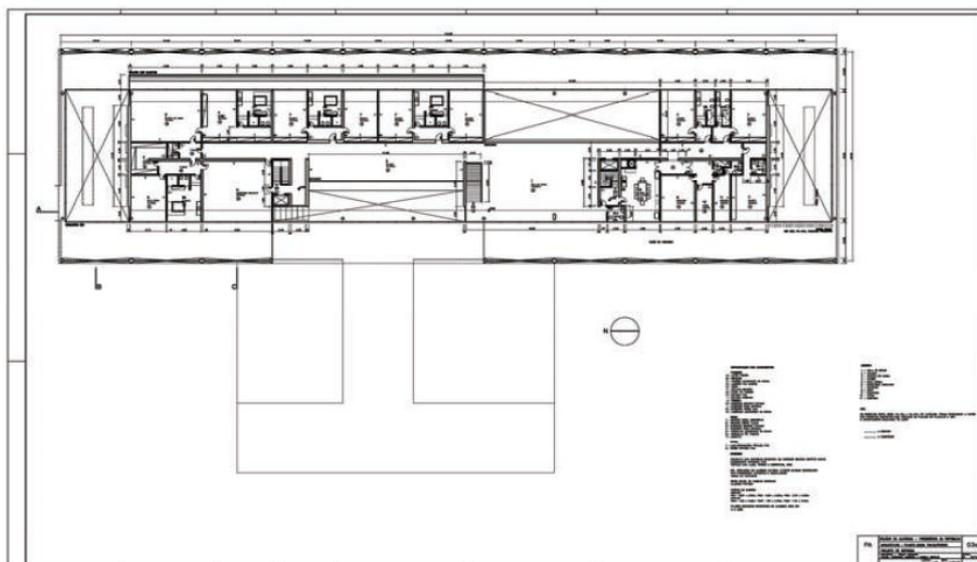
Planta Baixa Original – Pavimento Superior do Palácio da Alvorada.
